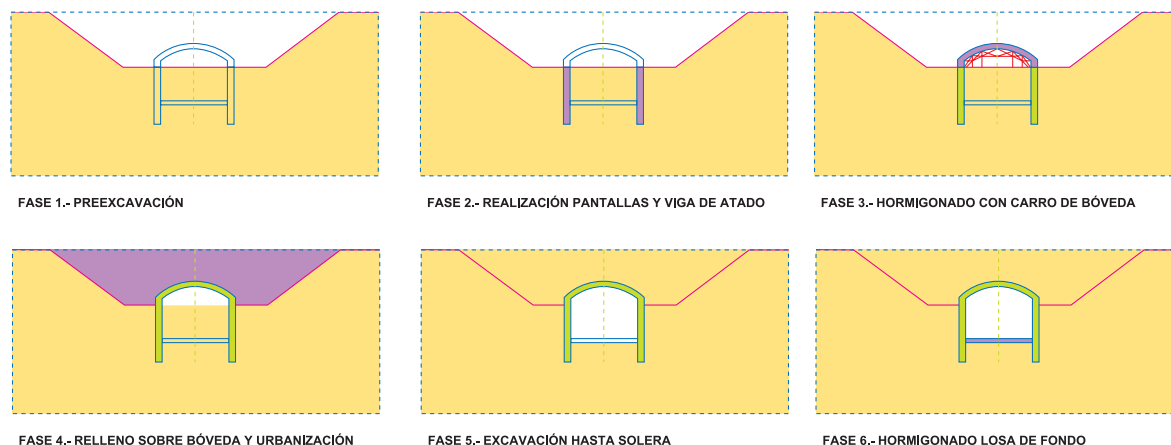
Fases constructivas de túnel con muros-pantalla.
